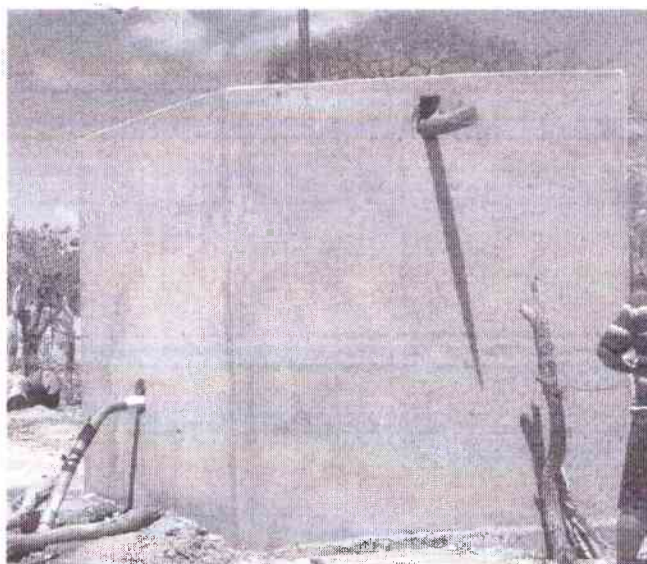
Casa de Bombas existente em construção no poço Pedro Cordeiro
